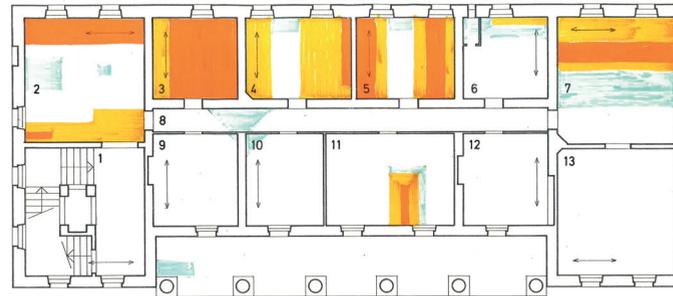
Grundriss Deckenzustand OG, 1983
